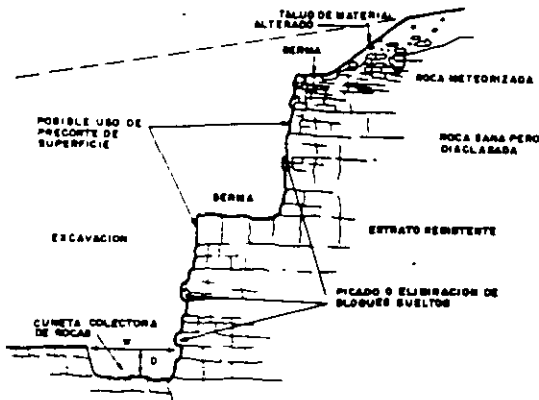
Tratamiento de la superficie inmediatamente después de la excavación.
